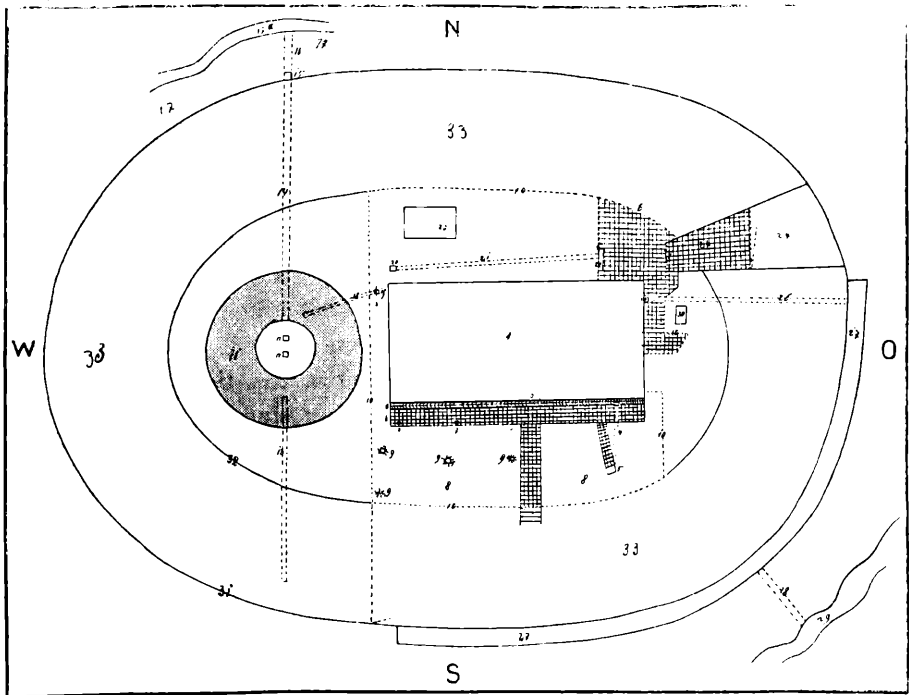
Grundriss einer einhäusigen Halligwerft, halbschematisch.
